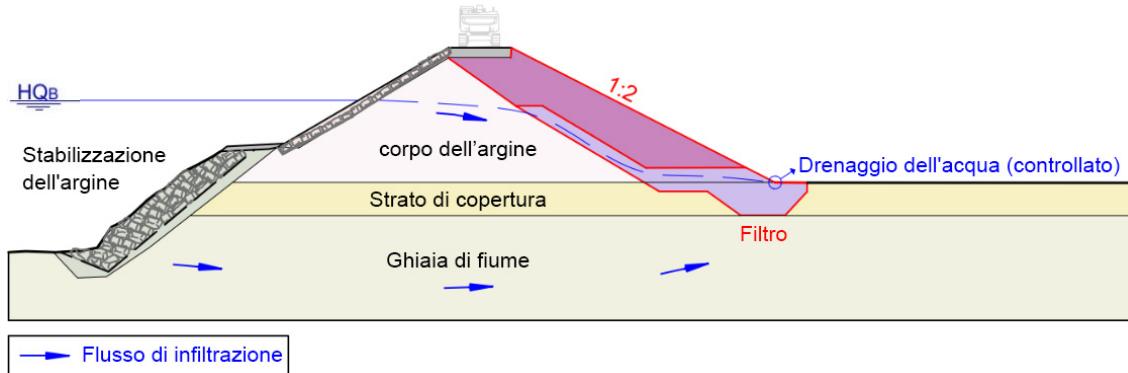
Sezione trasversale tipica di un argine nel caso di risanamento con sostituzione del materiale (strato filtrante in viola).
